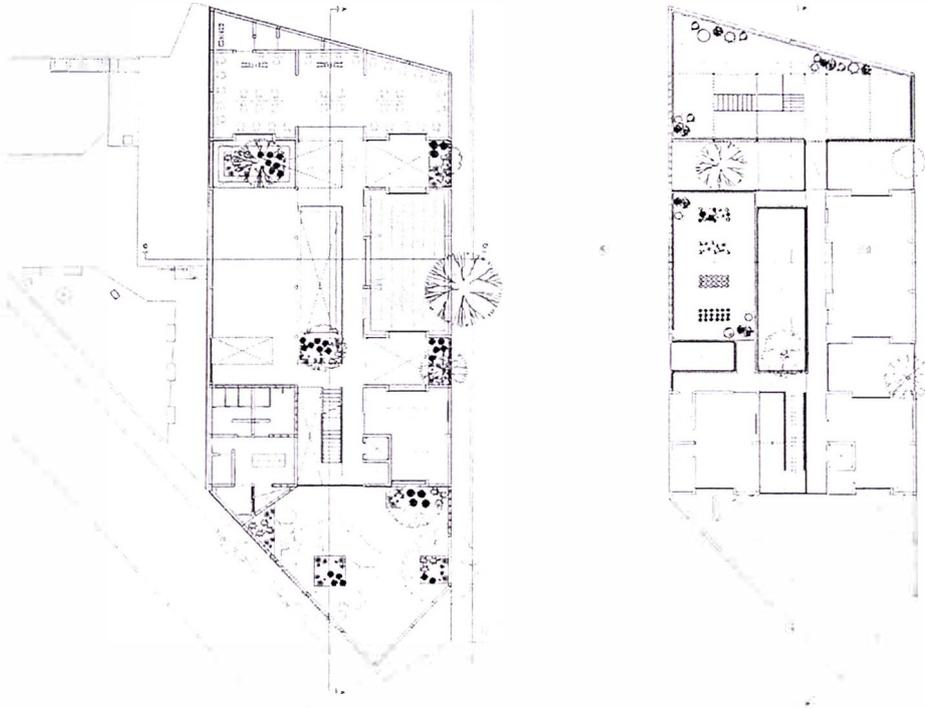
Vista planta nivel 01 y 02 Centro cultural Pilares.
